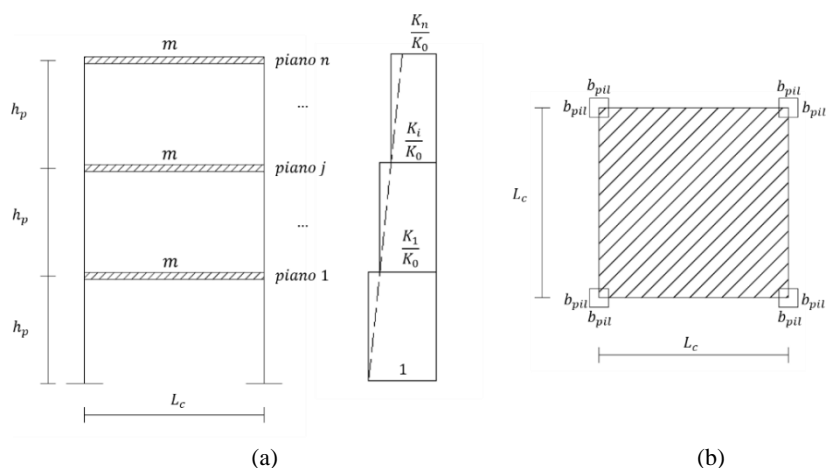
Modello strutturale semplificato rappresentato in elevazione (a) e in pianta (b).
